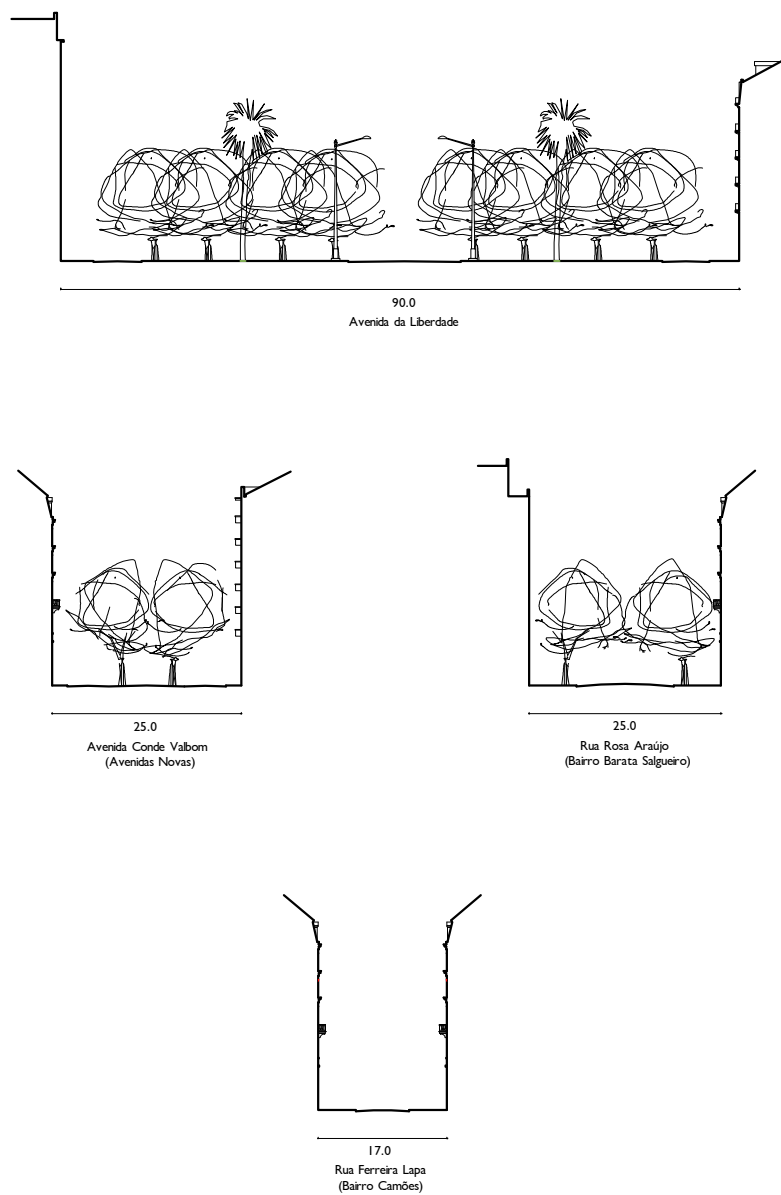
• Secções transversais-tipo das ruas do plano das Avenidas. (1:1.000).
